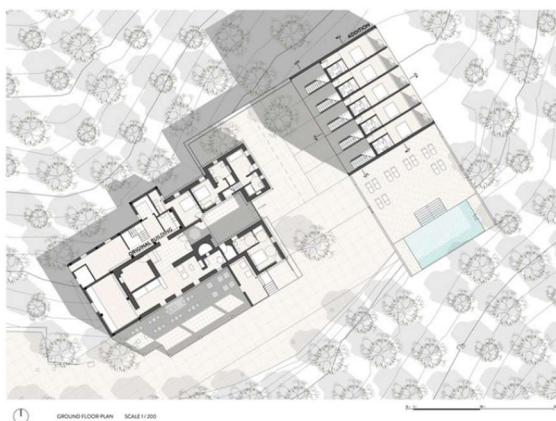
Planta Rés do Chão (Fonte: ArchDaily, 2020)
